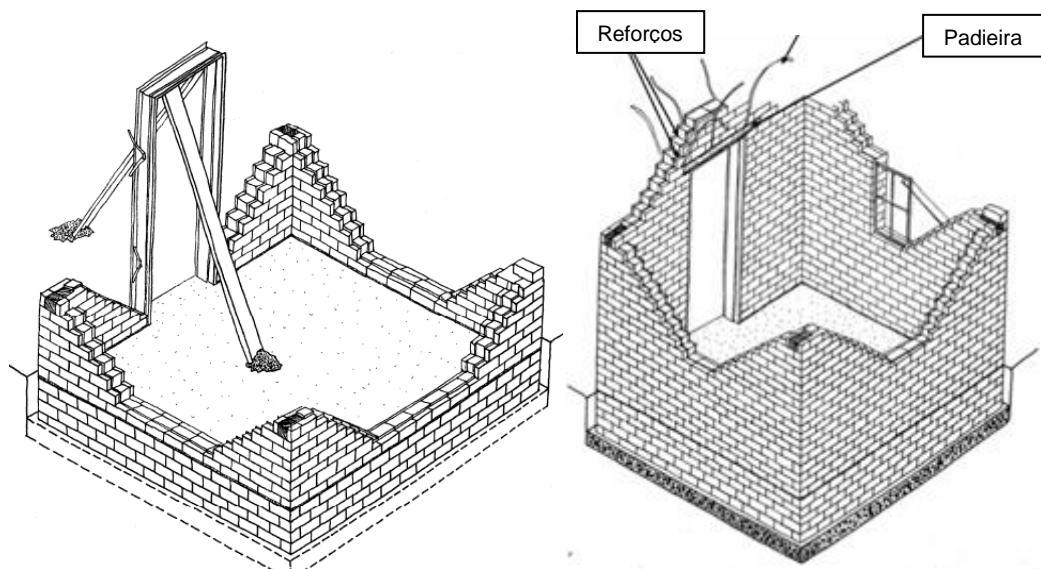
Execução dos Vãos de Portas e Janelas com Blocos da Hydraform
